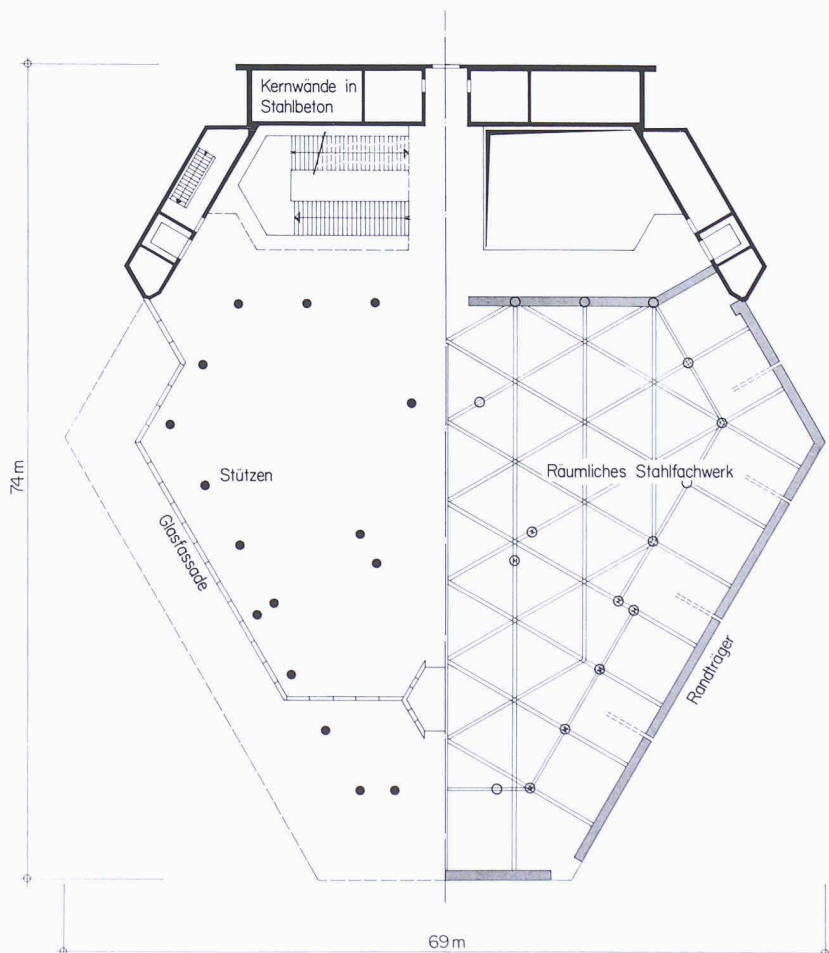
Schematischer Grundriss des ursprünglichen Gebäudes in der Eingangshalle (links) und im Hohlraum des Tragtisches mit räumlichem Stahlfachwerk (rechts)
